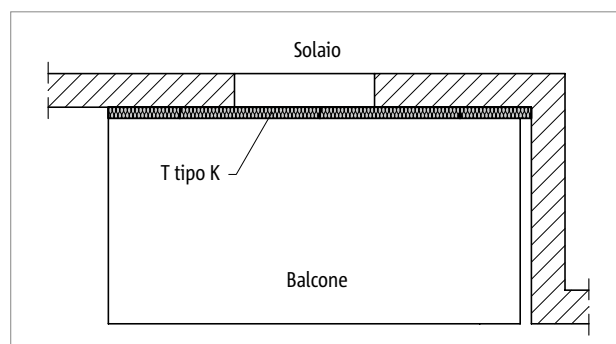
Schöck Isokorb® T tipo K: balcone con elemento sporgente nella facciata
